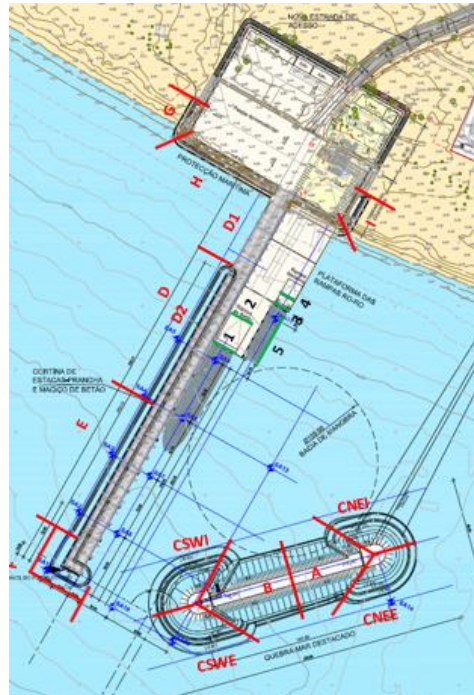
Porto Inglês: Planta das obras projetadas (CONSULMAR, 2019) e divisão em troços
